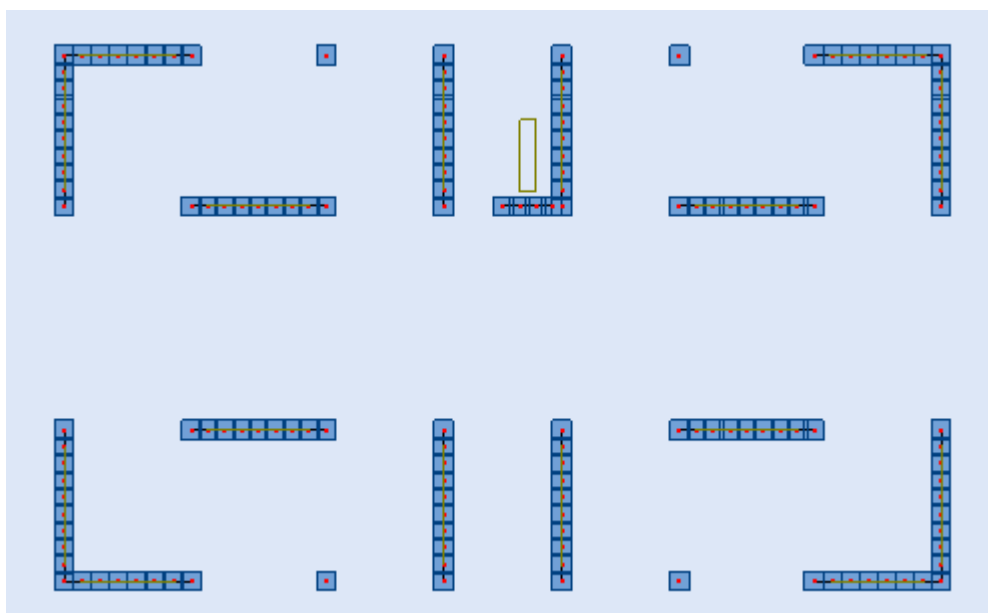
La 3^{ème} disposition des murs voiles et poteaux
